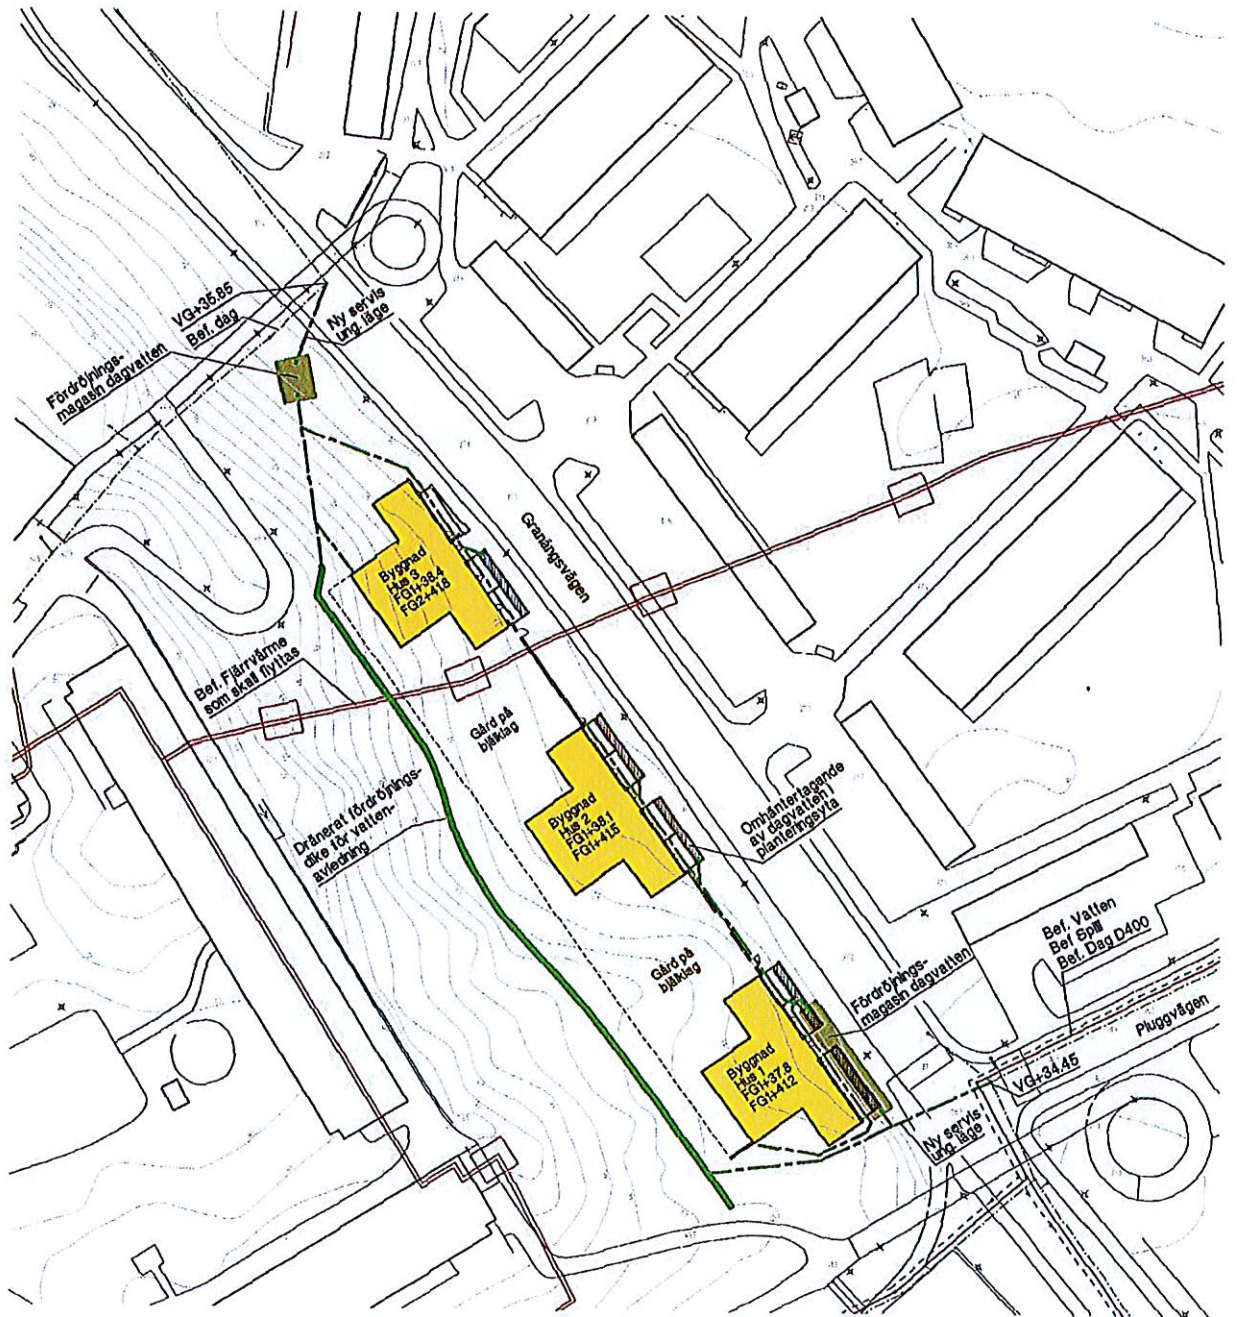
Planerad bebyggelse, bef. ledningar samt placering av fördröjningsmagasin och dränerat fördröjningsdike
